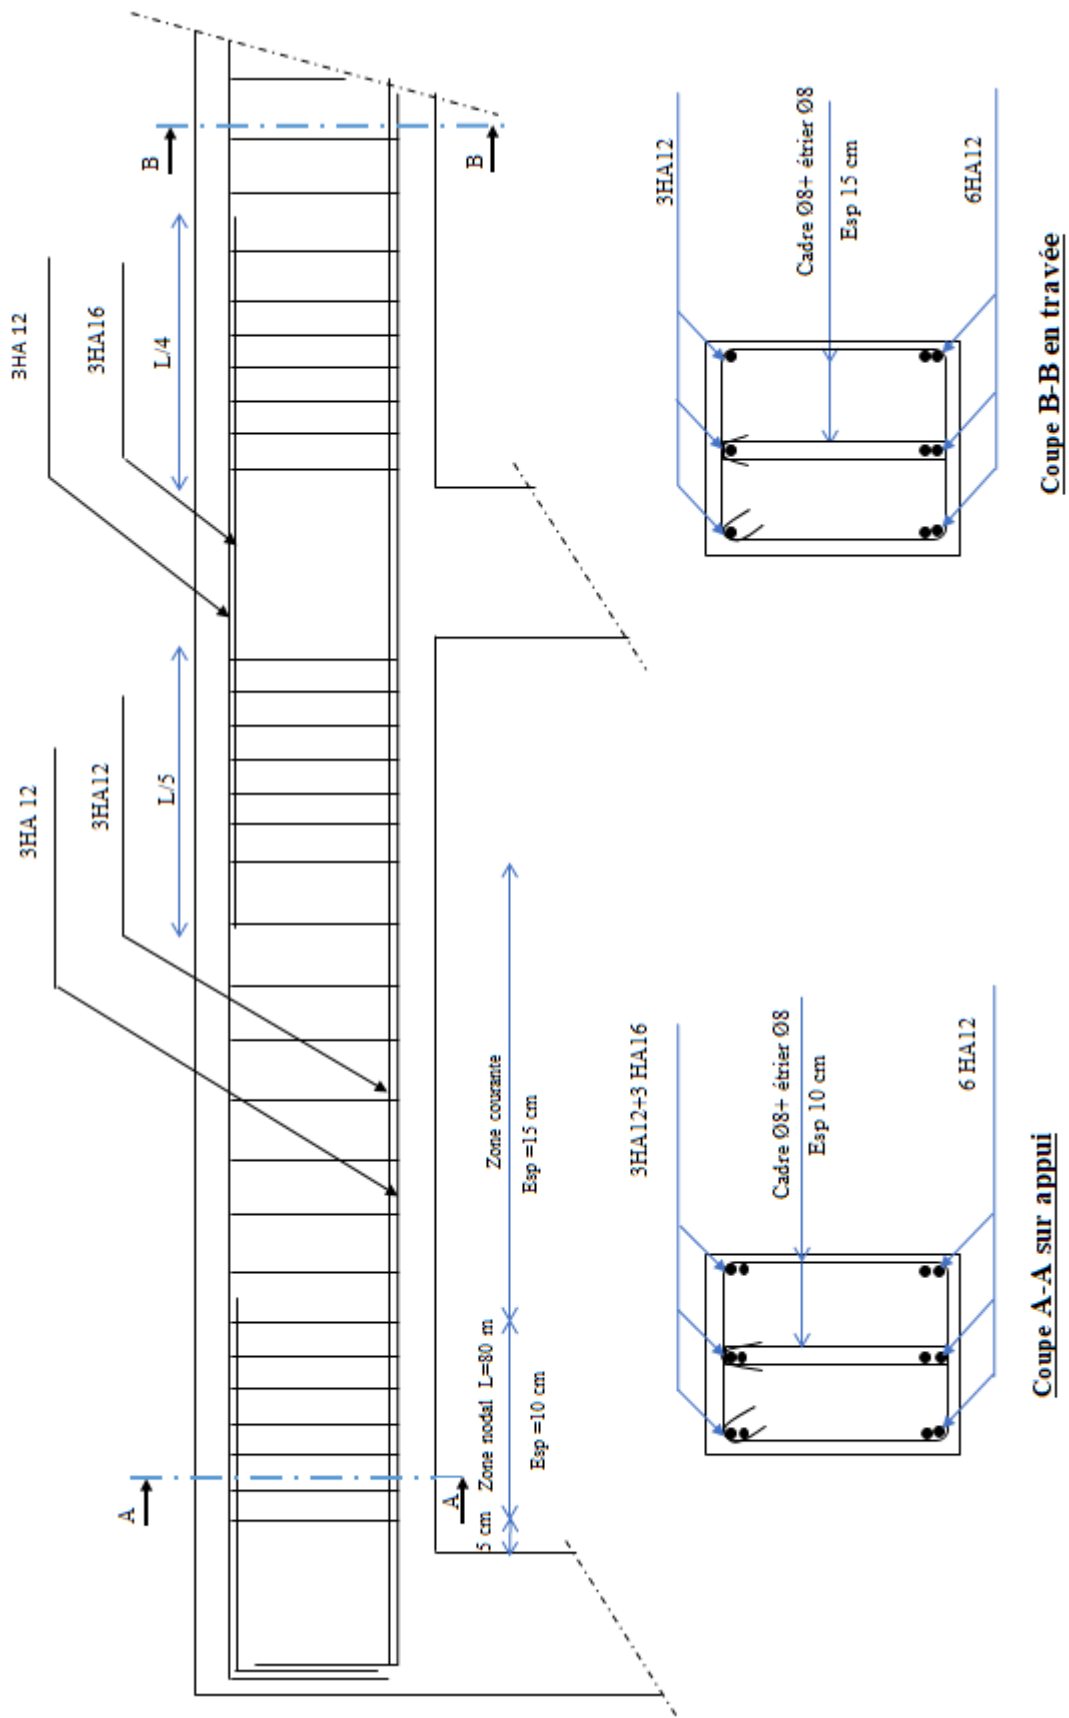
Schéma de ferrailage du poutres secondaires
